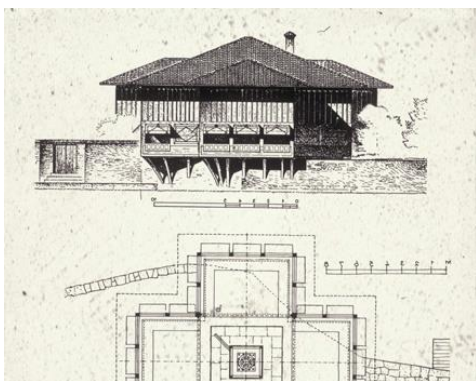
Fachada e planta do Yali Hüseyin Köprülü Pasha (<http://web.mit.edu/4.611/www/L16.html>).
